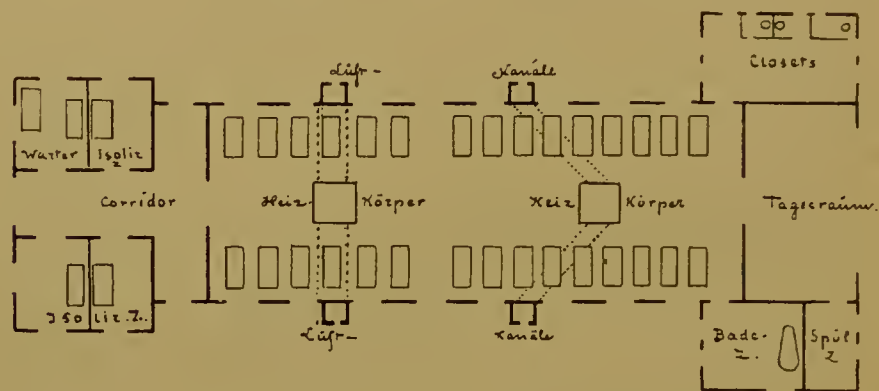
Pavillon des Hamburger Krankenhauses (nach Dencke).
